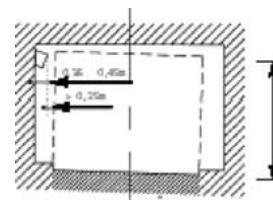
Perfil cuadrado instalación bilateral
